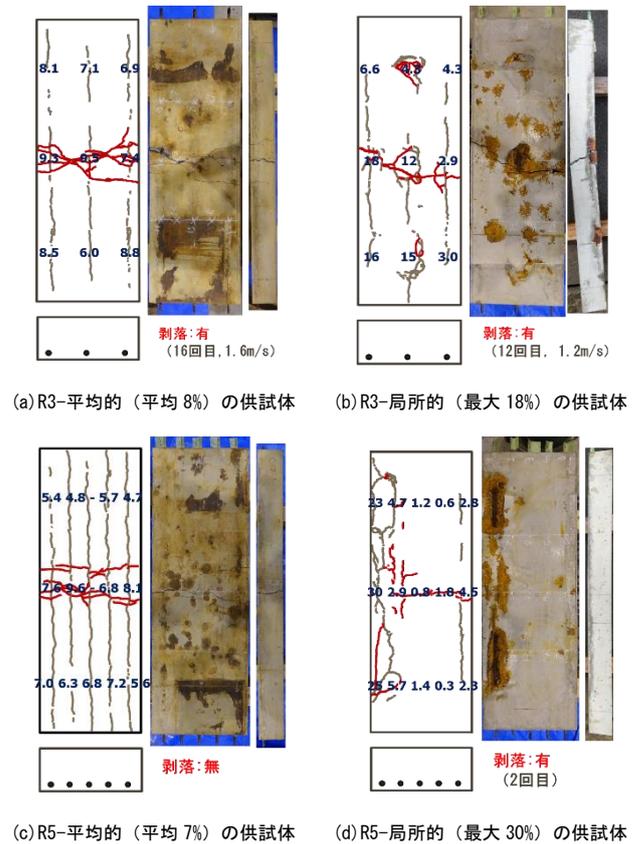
腐食と载荷によるひび割れと剥落位置
